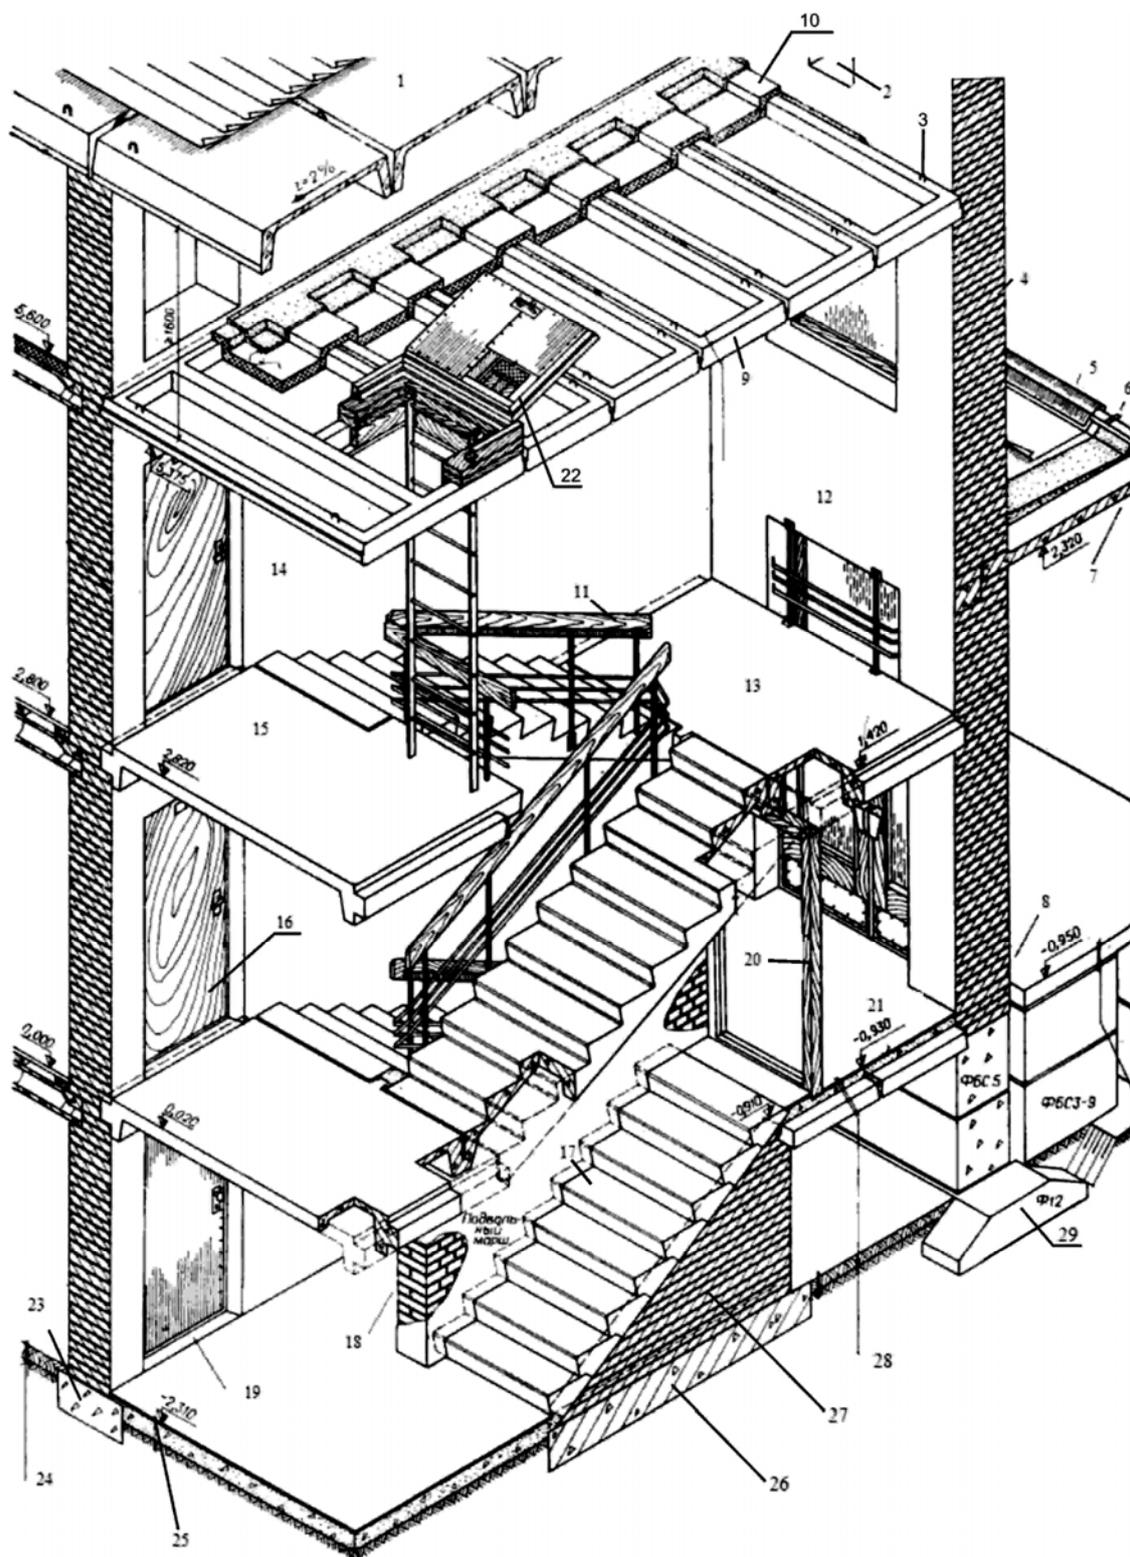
Лестничная клетка 2-, 3-этажного жилого дома с поперечными несущими кирпичными стенами: 1 — ж/б ребристые подкровельные плиты; 2 — продох, ограждаемый сеткой; 3 — монтажная петля; 4 — угол лестничной клетки; 5 — стальной фартук; 6 — костыль; 7 — консольный ж/б козырек; 8 — противоположная изоляция; 9 — плита чердачного перекрытия; 10 — утеплитель; 11 — перила лестницы; 12 — наружная стена; 13 — междуэтажная площадка; 14 — внутренняя стена; 15 — этажная площадка; 16 — входная дверь в квартиру; 17 — лестничный марш; 18 — цокольная несущая стена; 19 — нижний дверной порог; 20 — дверная коробка; 21 — входная плита; 22 — люк на чердак; 23 — фундамент под внутреннюю стену; 24 — глиняный затвор; 25 — монолитный пол подвала; 26 — фундамент под лестничный марш; 27 — ограждающая конструкция лестничного марша; 28 — несущая балка; 29 — фундаментная подушка
